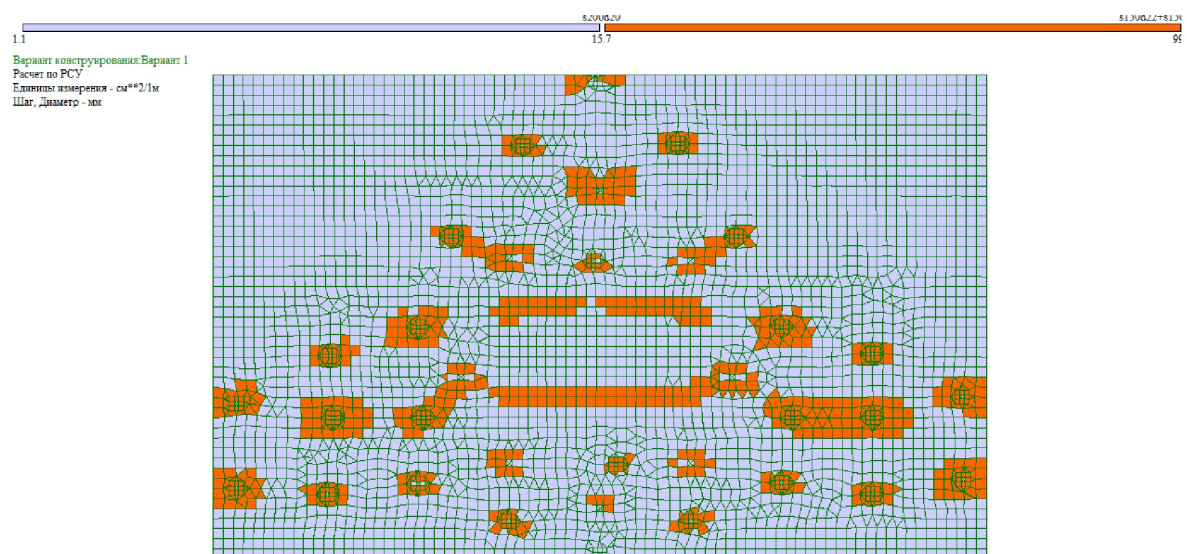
Армування фундаментної плити (Нижня по Y)
